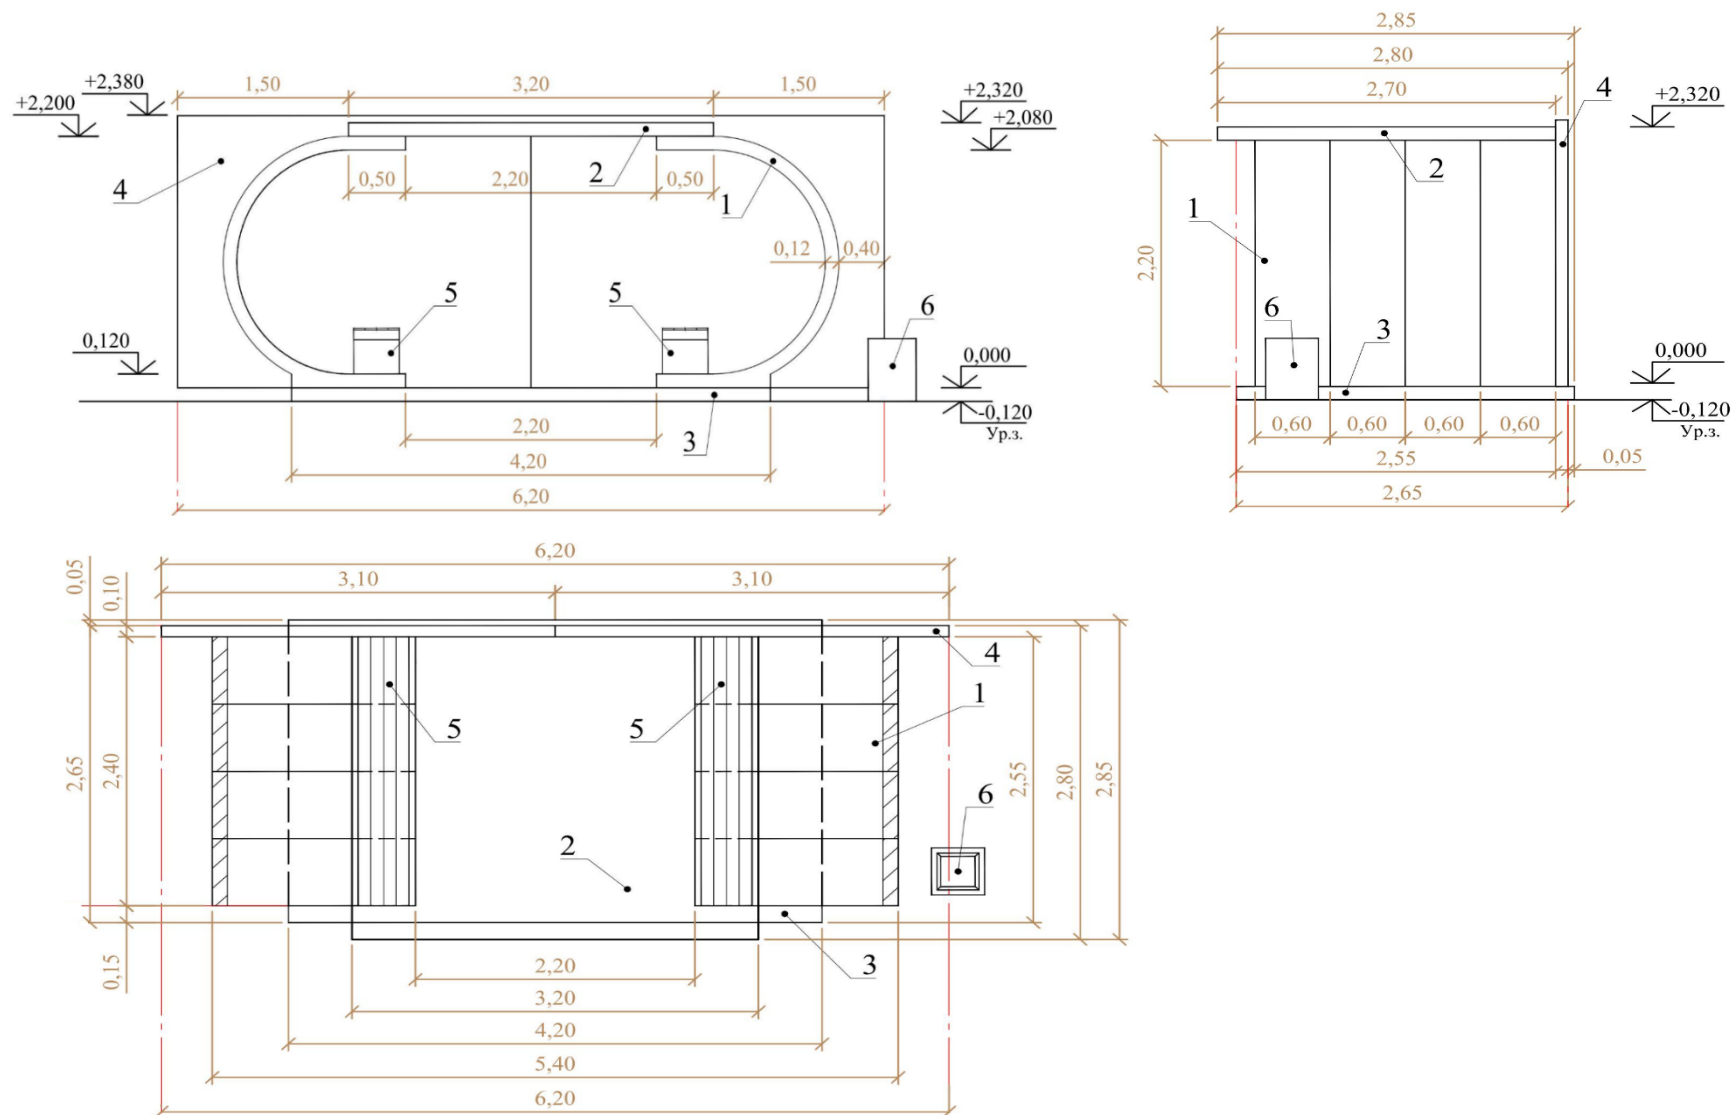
Автопавильон, выполненный из железобетонных конструкций
